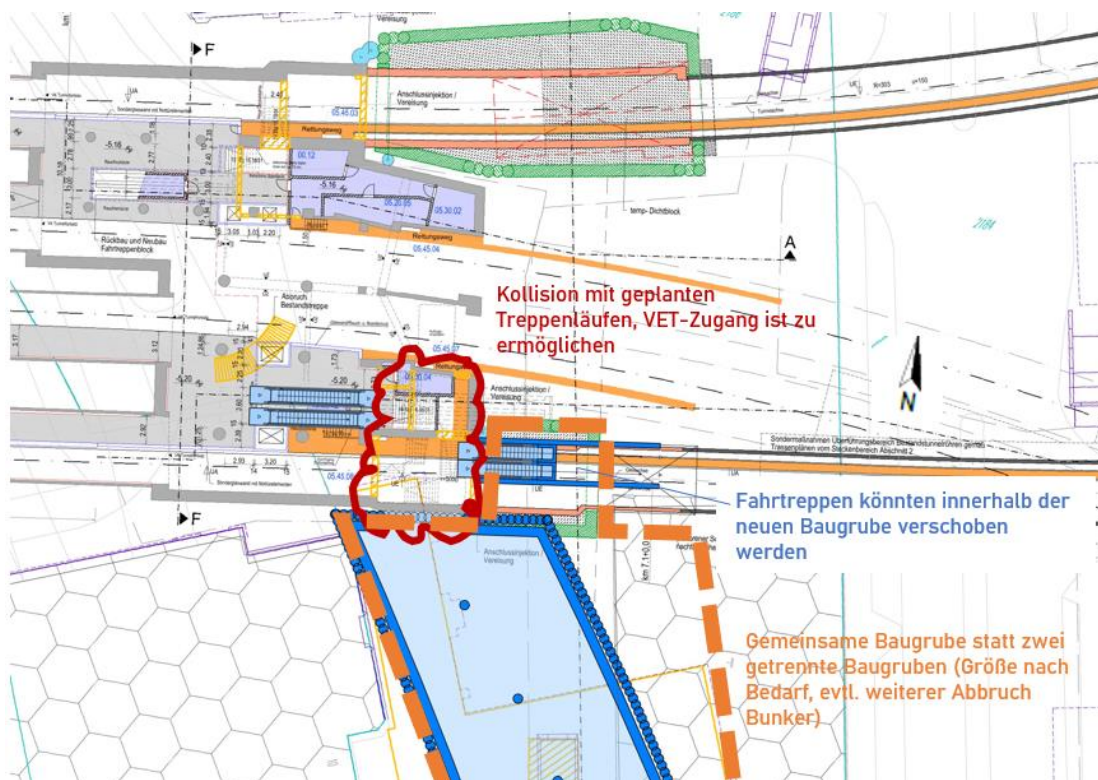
Hbf, Schnittstelle VET mit U5 HB, Halle Ost, Grundriss Bahnsteigebene [U9]
